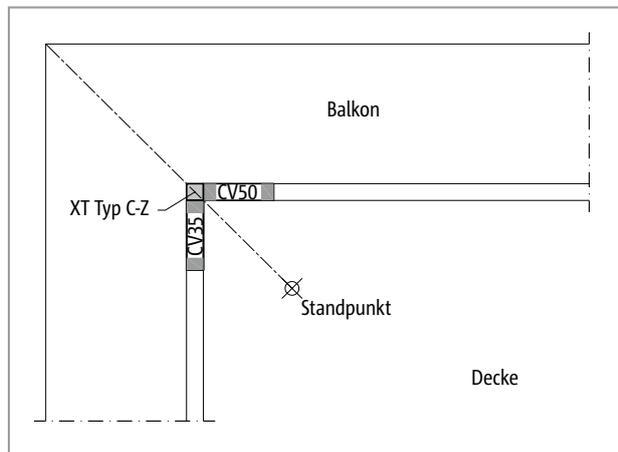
Schöck Isokorb® XT Typ C: Betondeckung wählbar: Hier CV35 links vom Standpunkt, Betondeckung CV50 rechts vom Standpunkt
